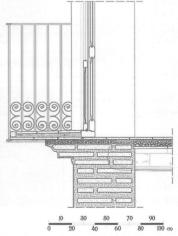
Alzado y sección constructiva de un balcón de calle En Bou
